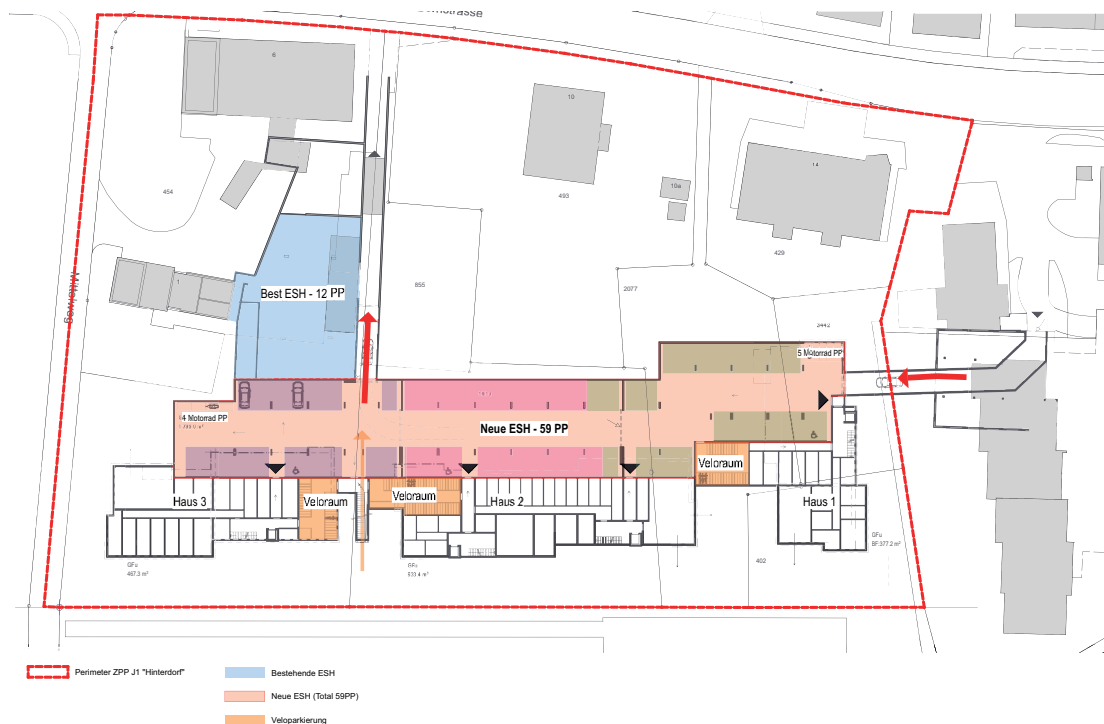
Untergeschoss mit neuer Einstellhalle inkl. Zu- und Wegfahrt (Quelle: GIM Architekten AG, Juni 2024)
